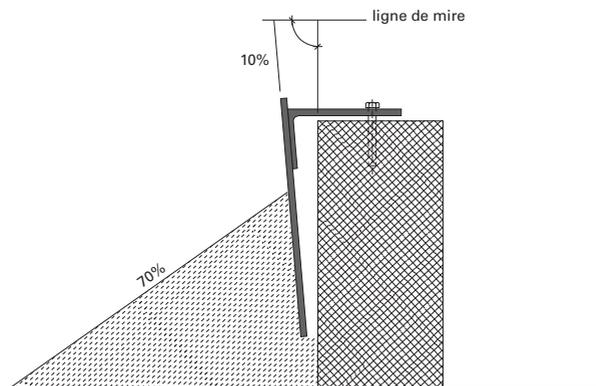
Parapet équipé d'une plaque blindée renforcée réglementaire
